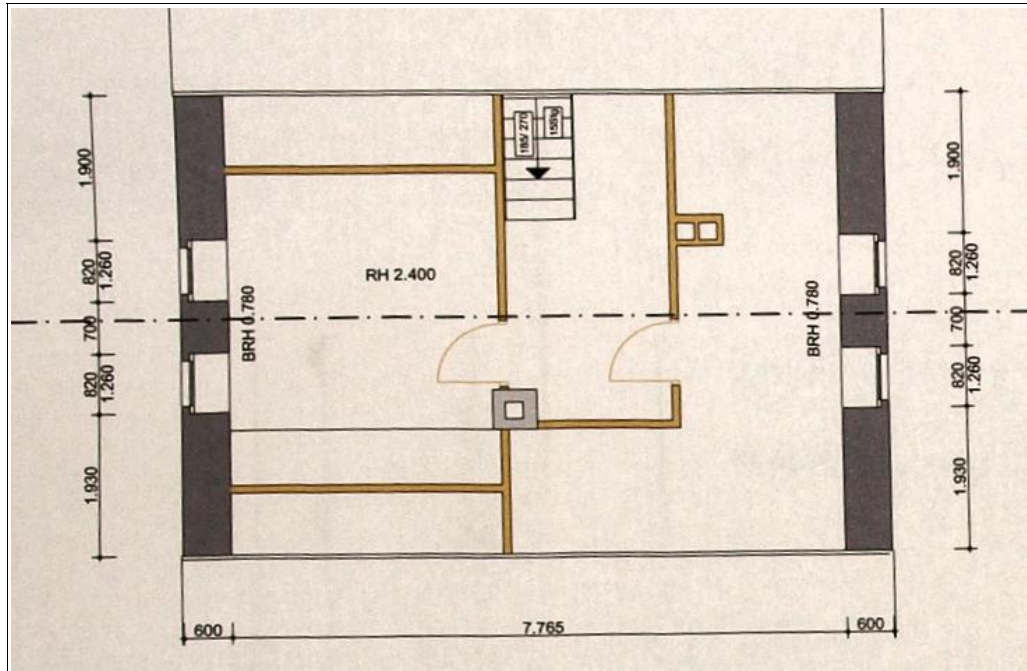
Grundriss Dachgeschoss (EFH)
